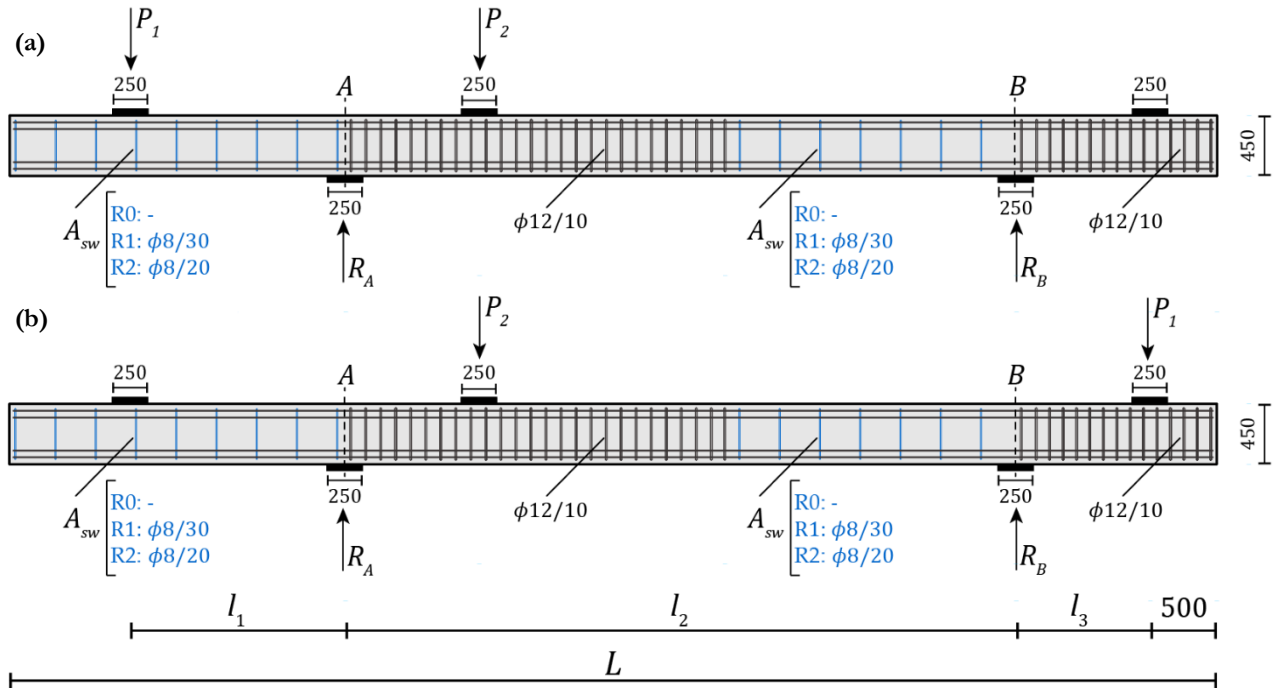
Detalle de la geometría y la armadura transversal: (a) ensayo de voladizo (CE); (b) ensayo de vano (SE). (Cotas en mm).
